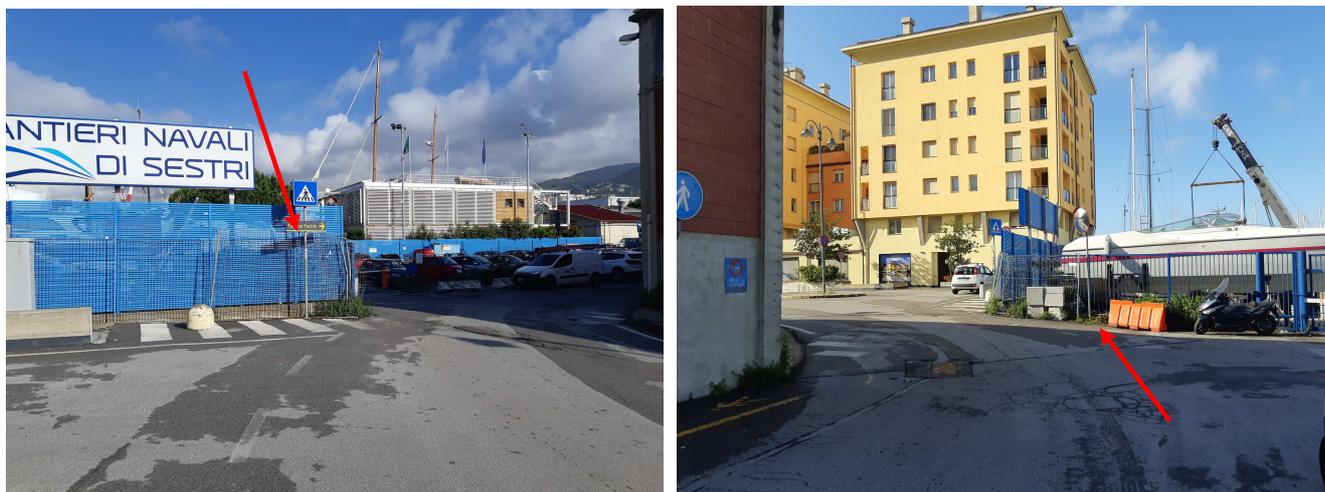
Concessione Cantieri Navali di Sestri oggetto di riduzione
